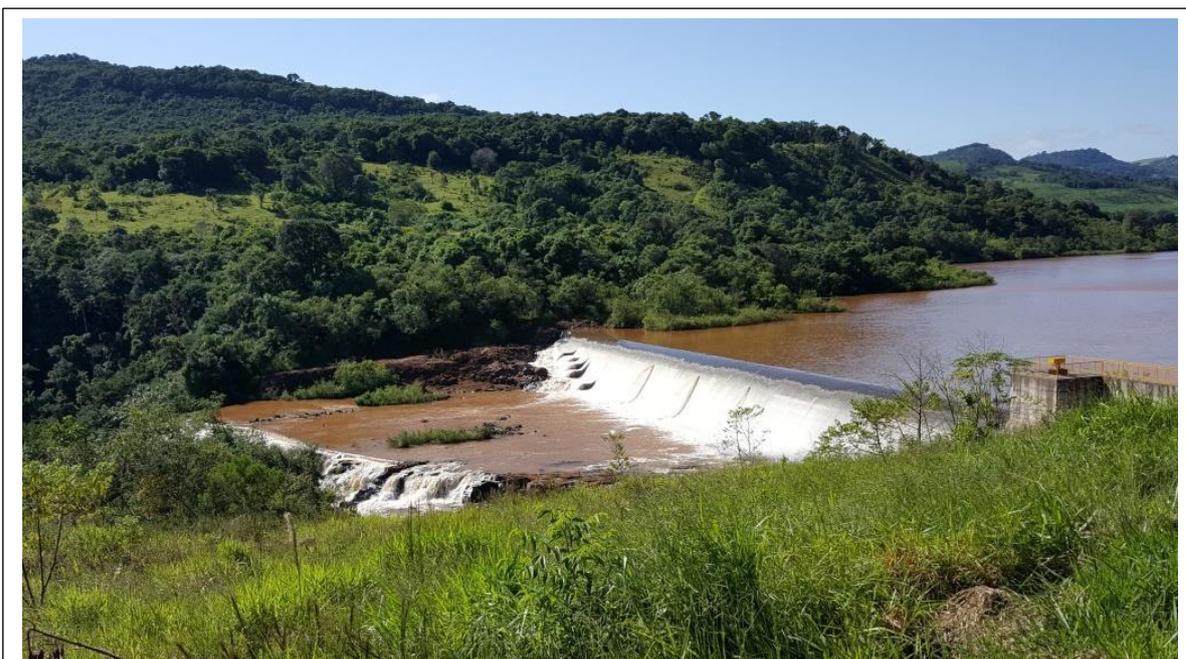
Vista panorâmica Ponto 02: Barragem, em 2015
